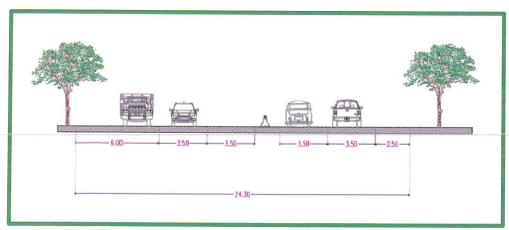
Sección tipo del tramo 1+320 - 1+440.
